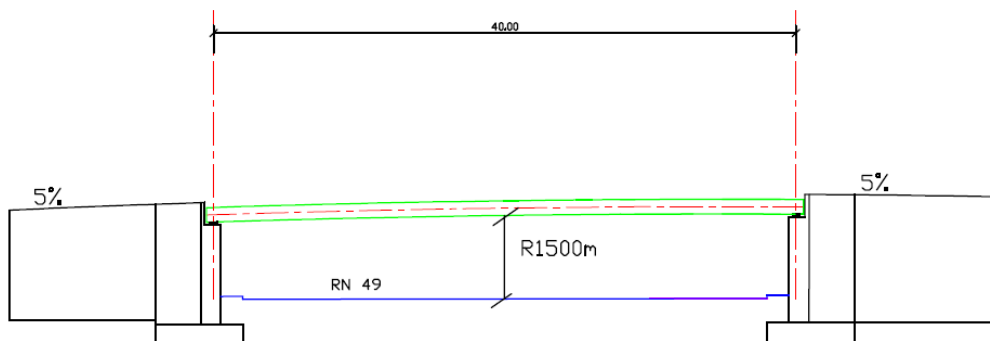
Plan d'aménagement au niveau de l'ouvrage.
